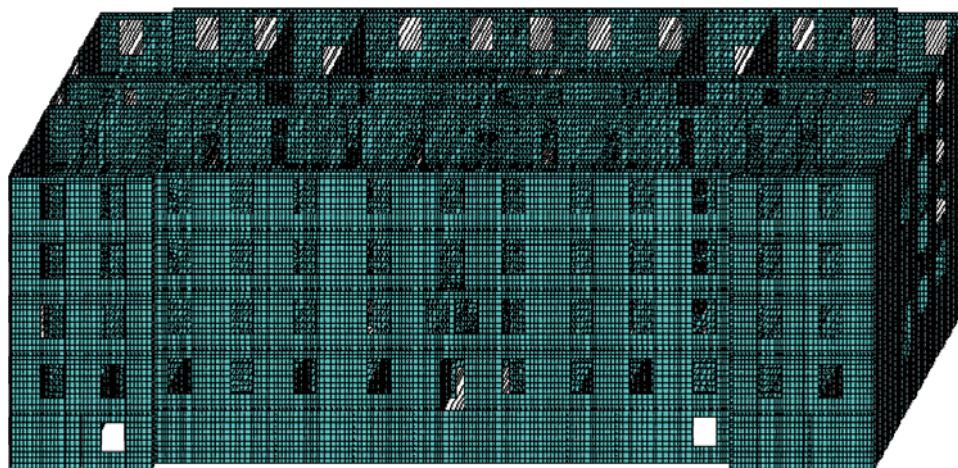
Розрахункова схема моделі будівлі з врахуванням надбудови додаткового поверху
